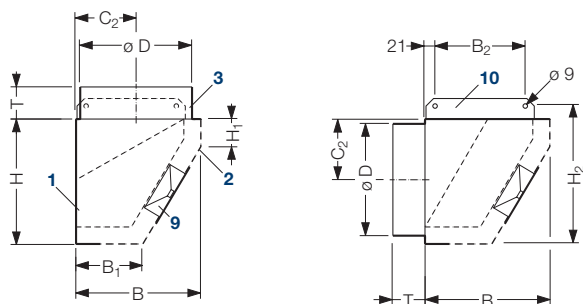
Trapezförmiger Verdrängungsauslass, Abmessungen
